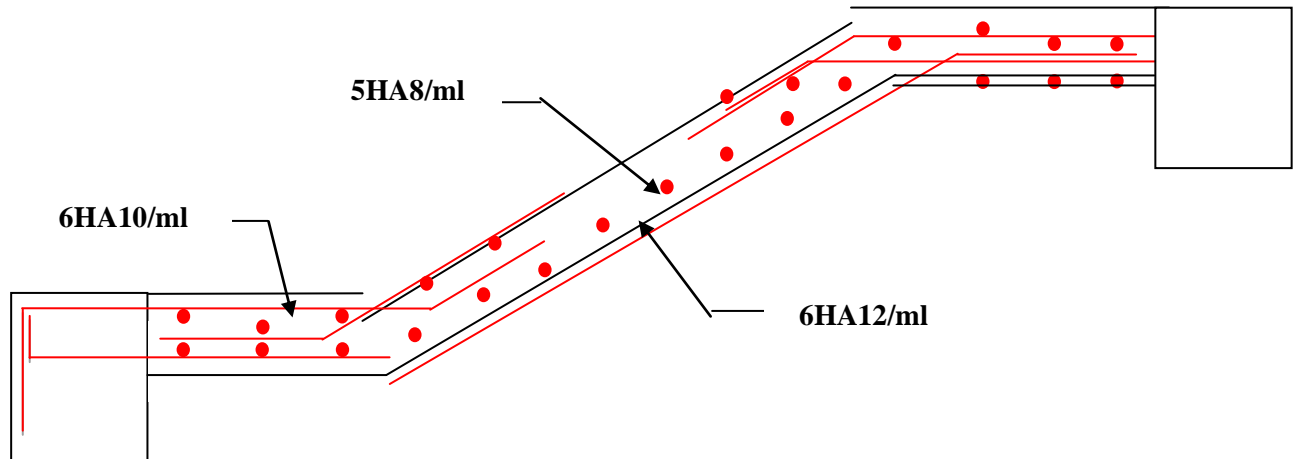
Schéma de ferrailage de la partie 1 de l'escalier.
